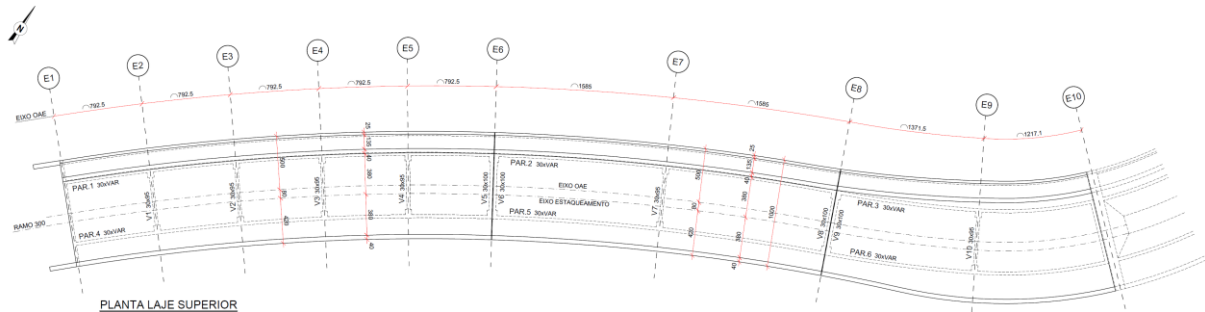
RAMO 300 - PLANTA ENCONTRO ESTRUTURADO (EIXOS E1 A E10)
